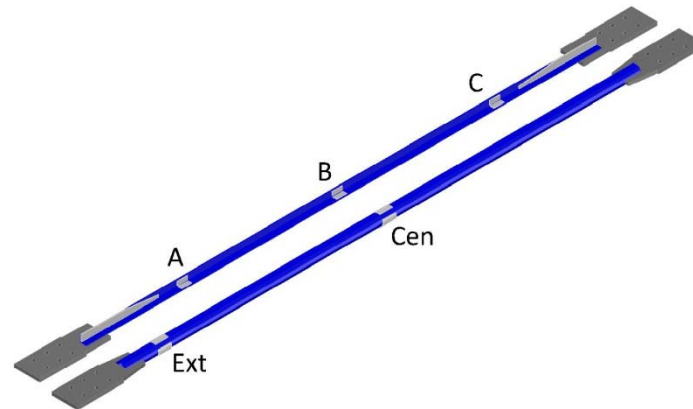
Colocación de deformímetros eléctricos (Strain Gages)
